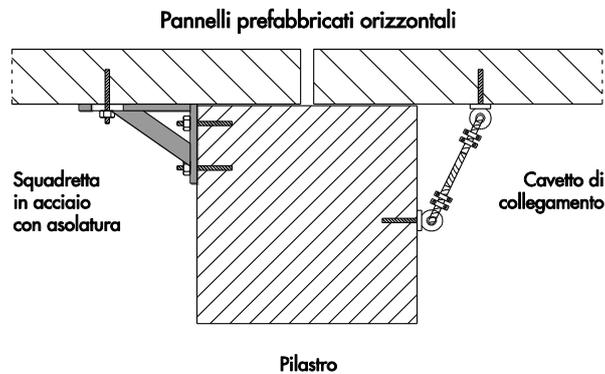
Collegamento pilastro – pannelli prefabbricati orizzontali con squadrette in acciaio con asolatura orizzontale (sinistra) o cavetti in acciaio (destra).
